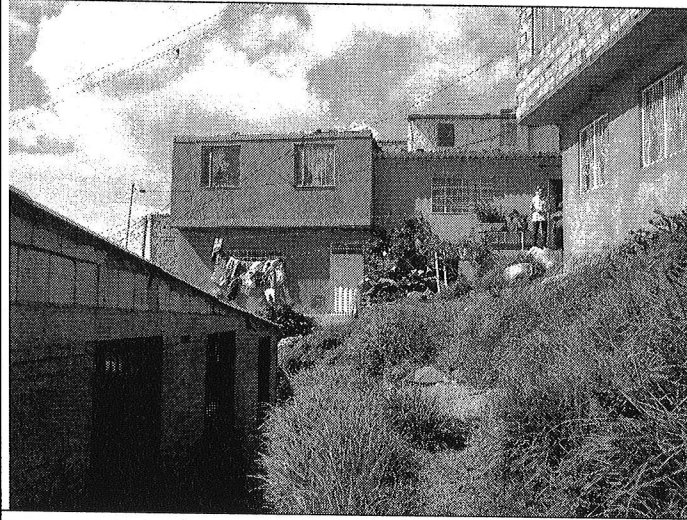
Vista general del lotes 5 y 7 de la manzana 10 (Observar Figura 1).
